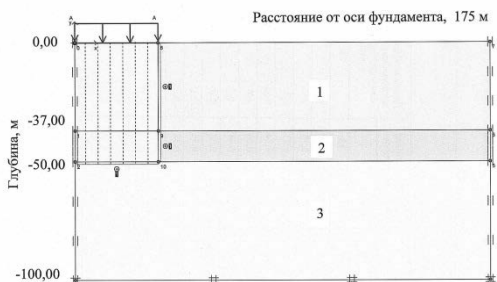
Расчетная схема к определению осадки подошвы фундамента высотного Здания
